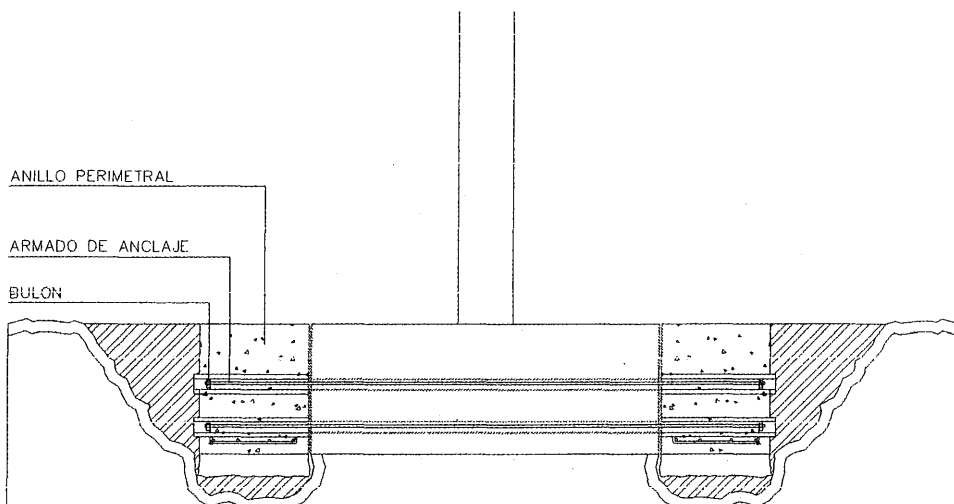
Recalce superficial de zapata aislada aumentando su superficie de apoyo mediante un anillo perimetral unido por armaduras pasantes con bulones y postesadas.
